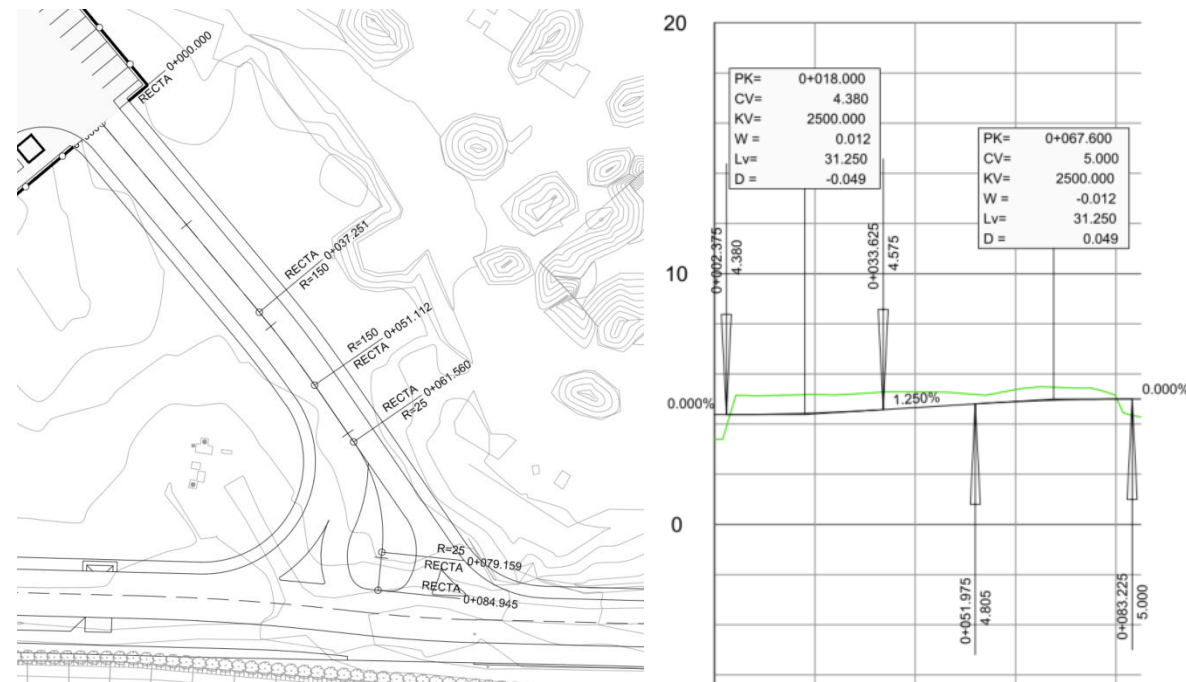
Planta de trazado y perfil longitudinal del vial de acceso a cocheras
